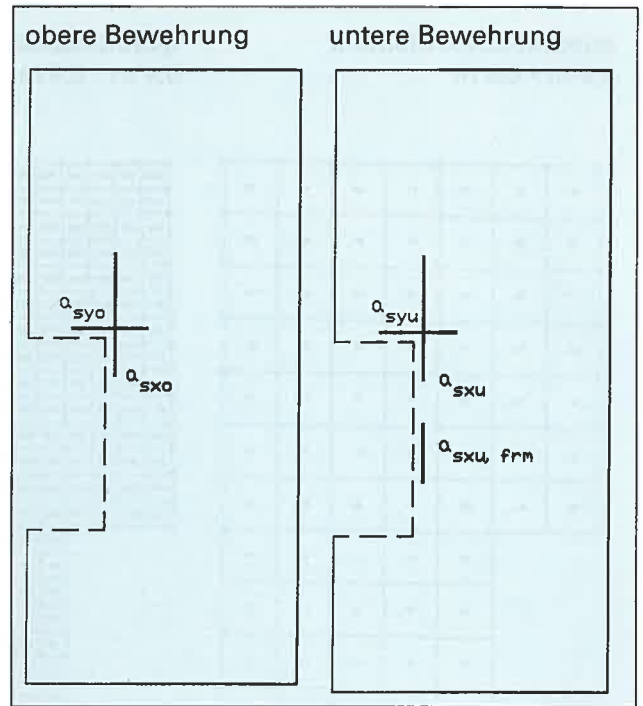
Deckenplatte eines Reihenhauses – Lage der ermittelten Bewehrungsquerschnitte
